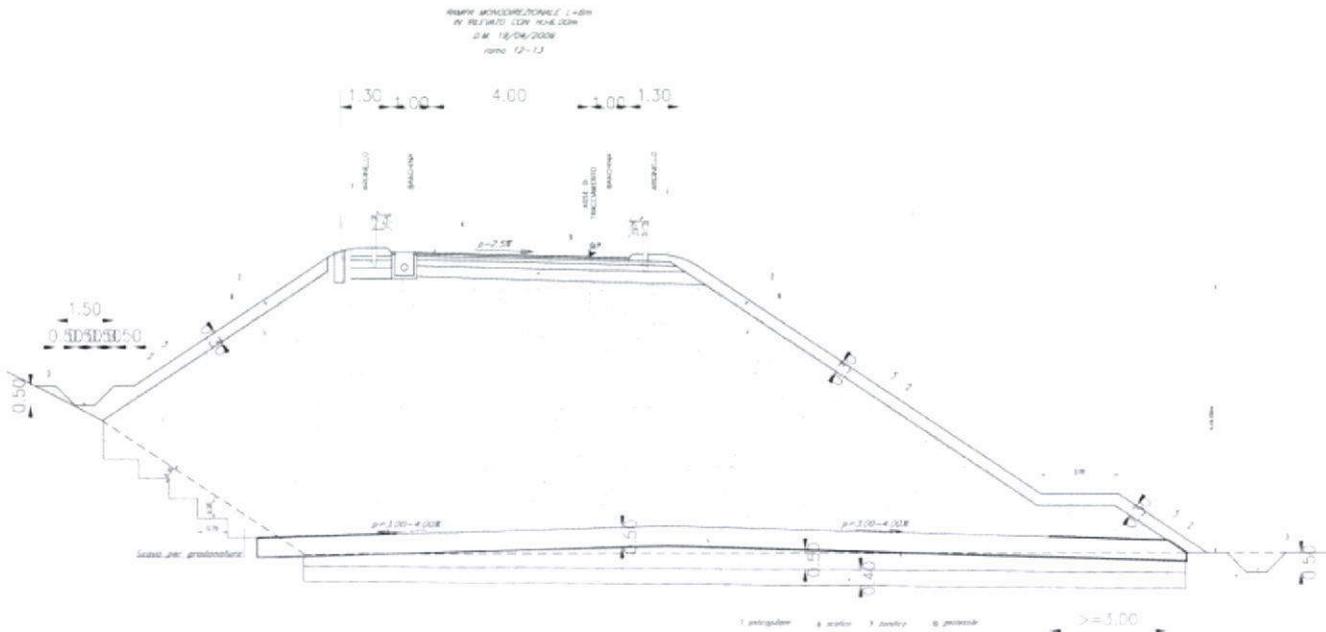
Sezione tipo rampa monodirezionale in rilevato alto
